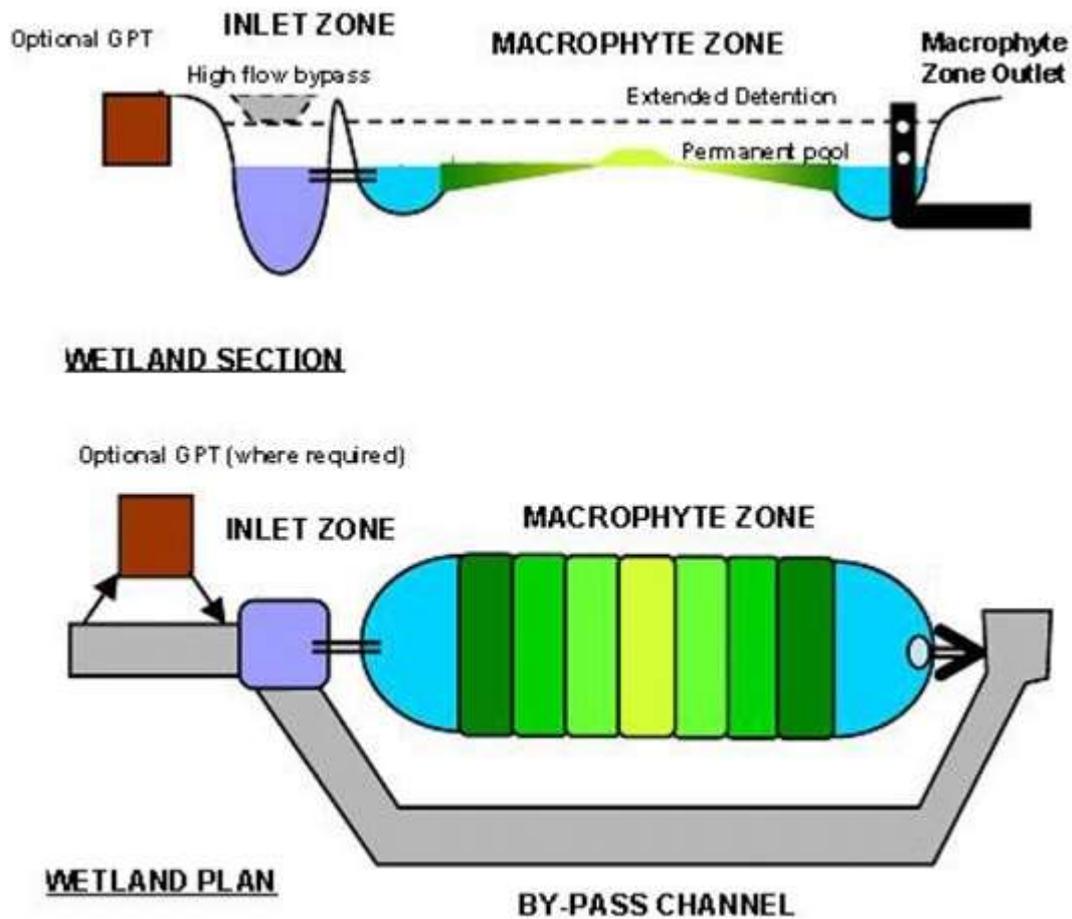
Planta e seção longitudinal esquemáticos de uma wetland
